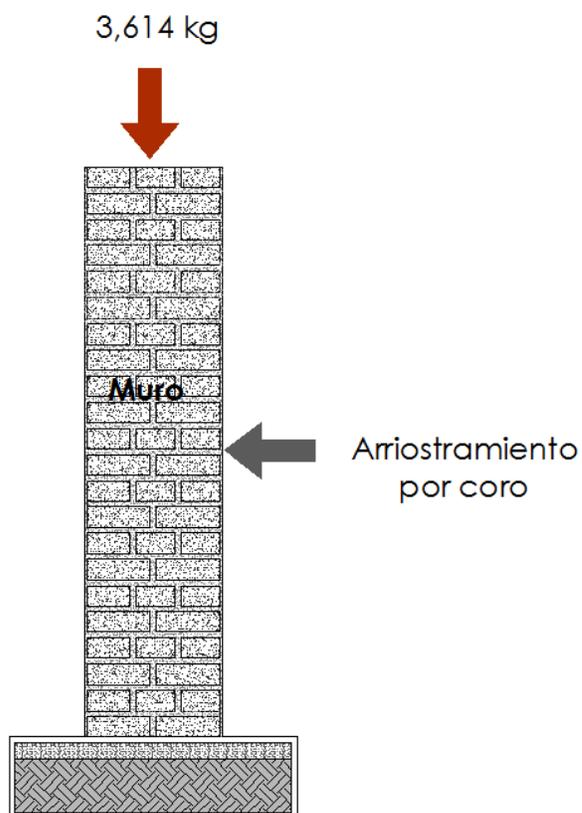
Muro cargado axialmente y arriestrado. Elaboró: Ramón Holguín.
